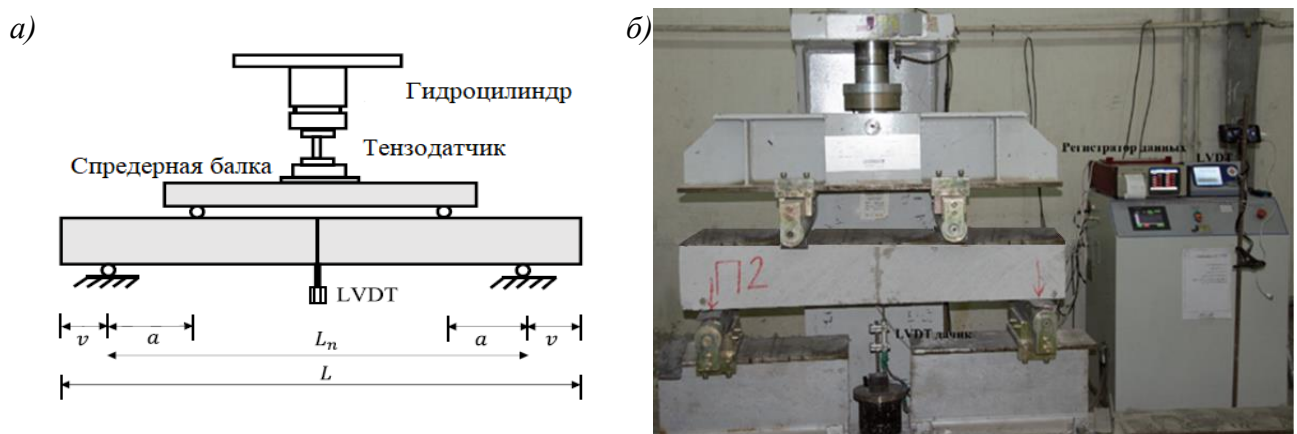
Система загрузки: а – схема испытаний перемычек; б – установка для испытаний: L – длина балки; L_n – длина пролета в свету; a – пролет сдвига
